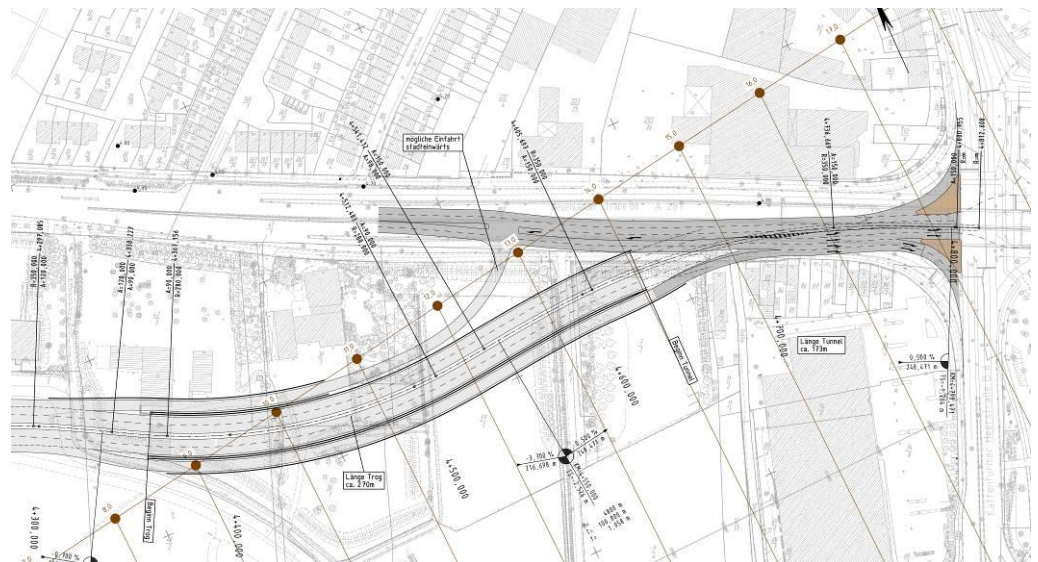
Vierarmiger Knotenpunkt und teilweise plangleiche Rampenanbindung
